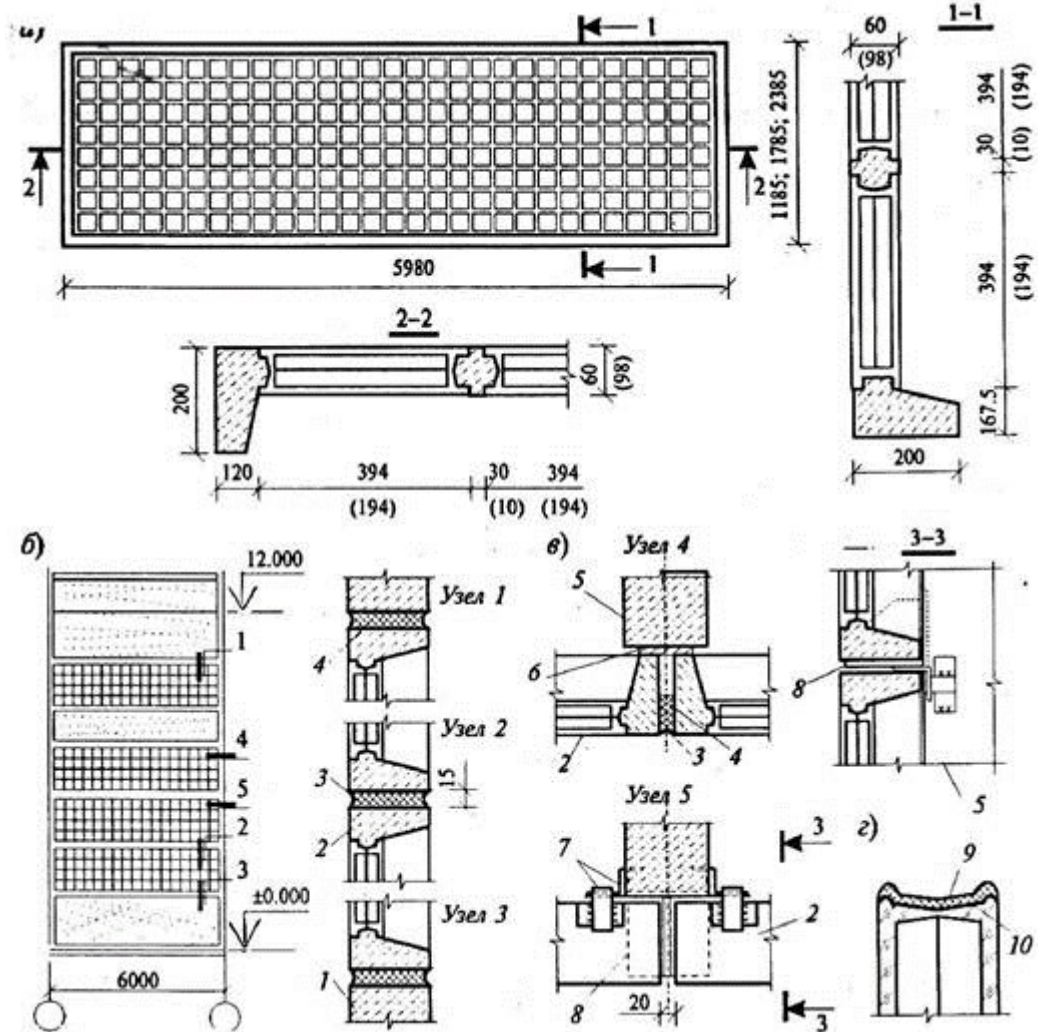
Стекложелезобетонные оконные панели:
